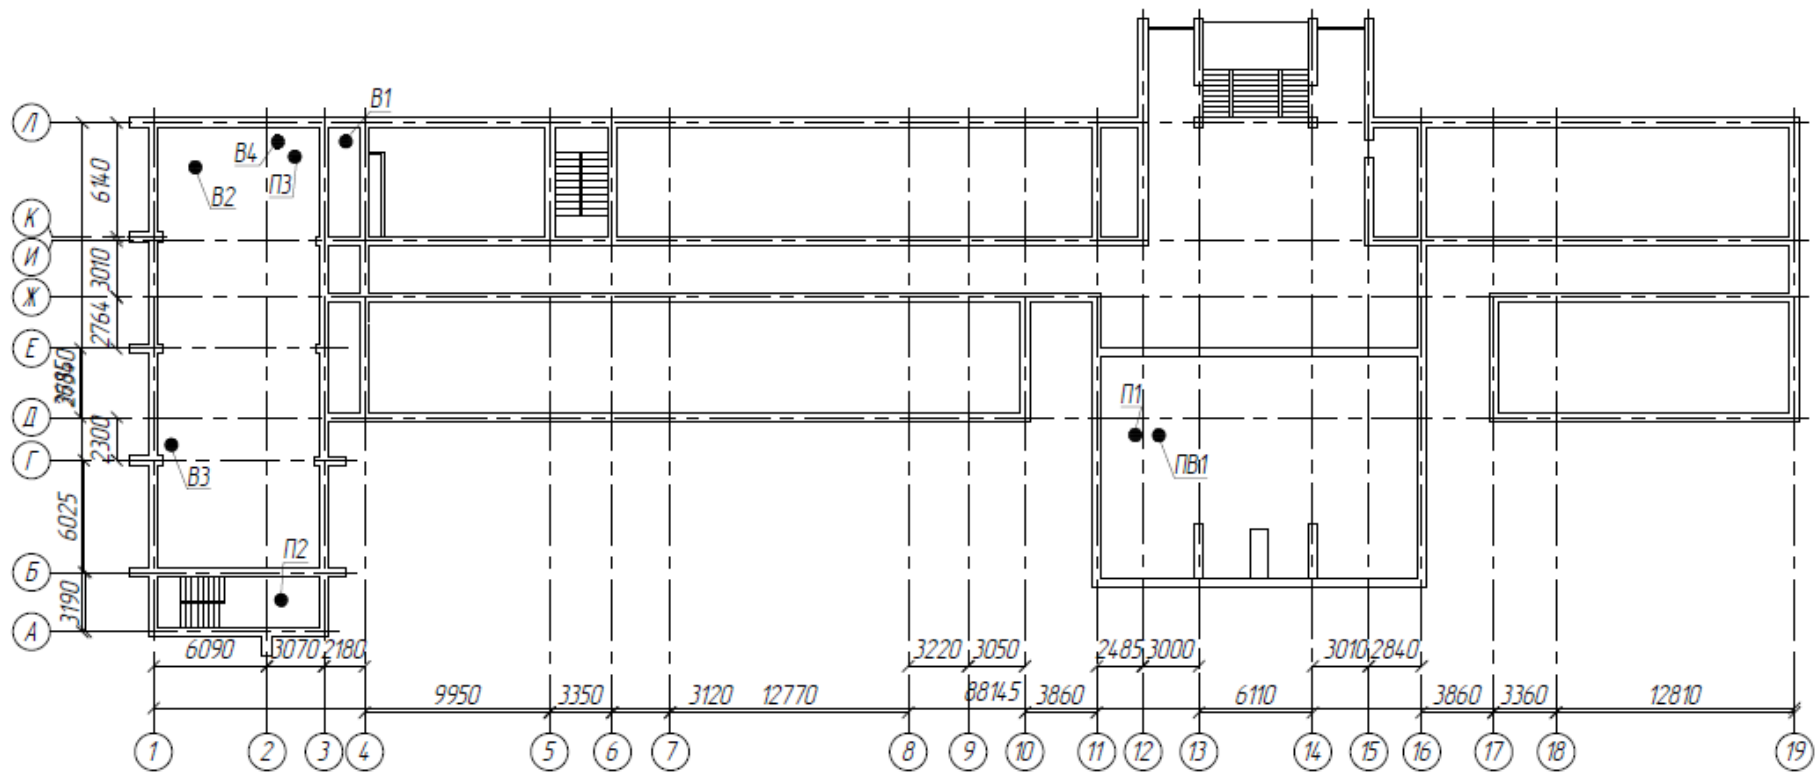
План-схема размещения вентиляционных установок
